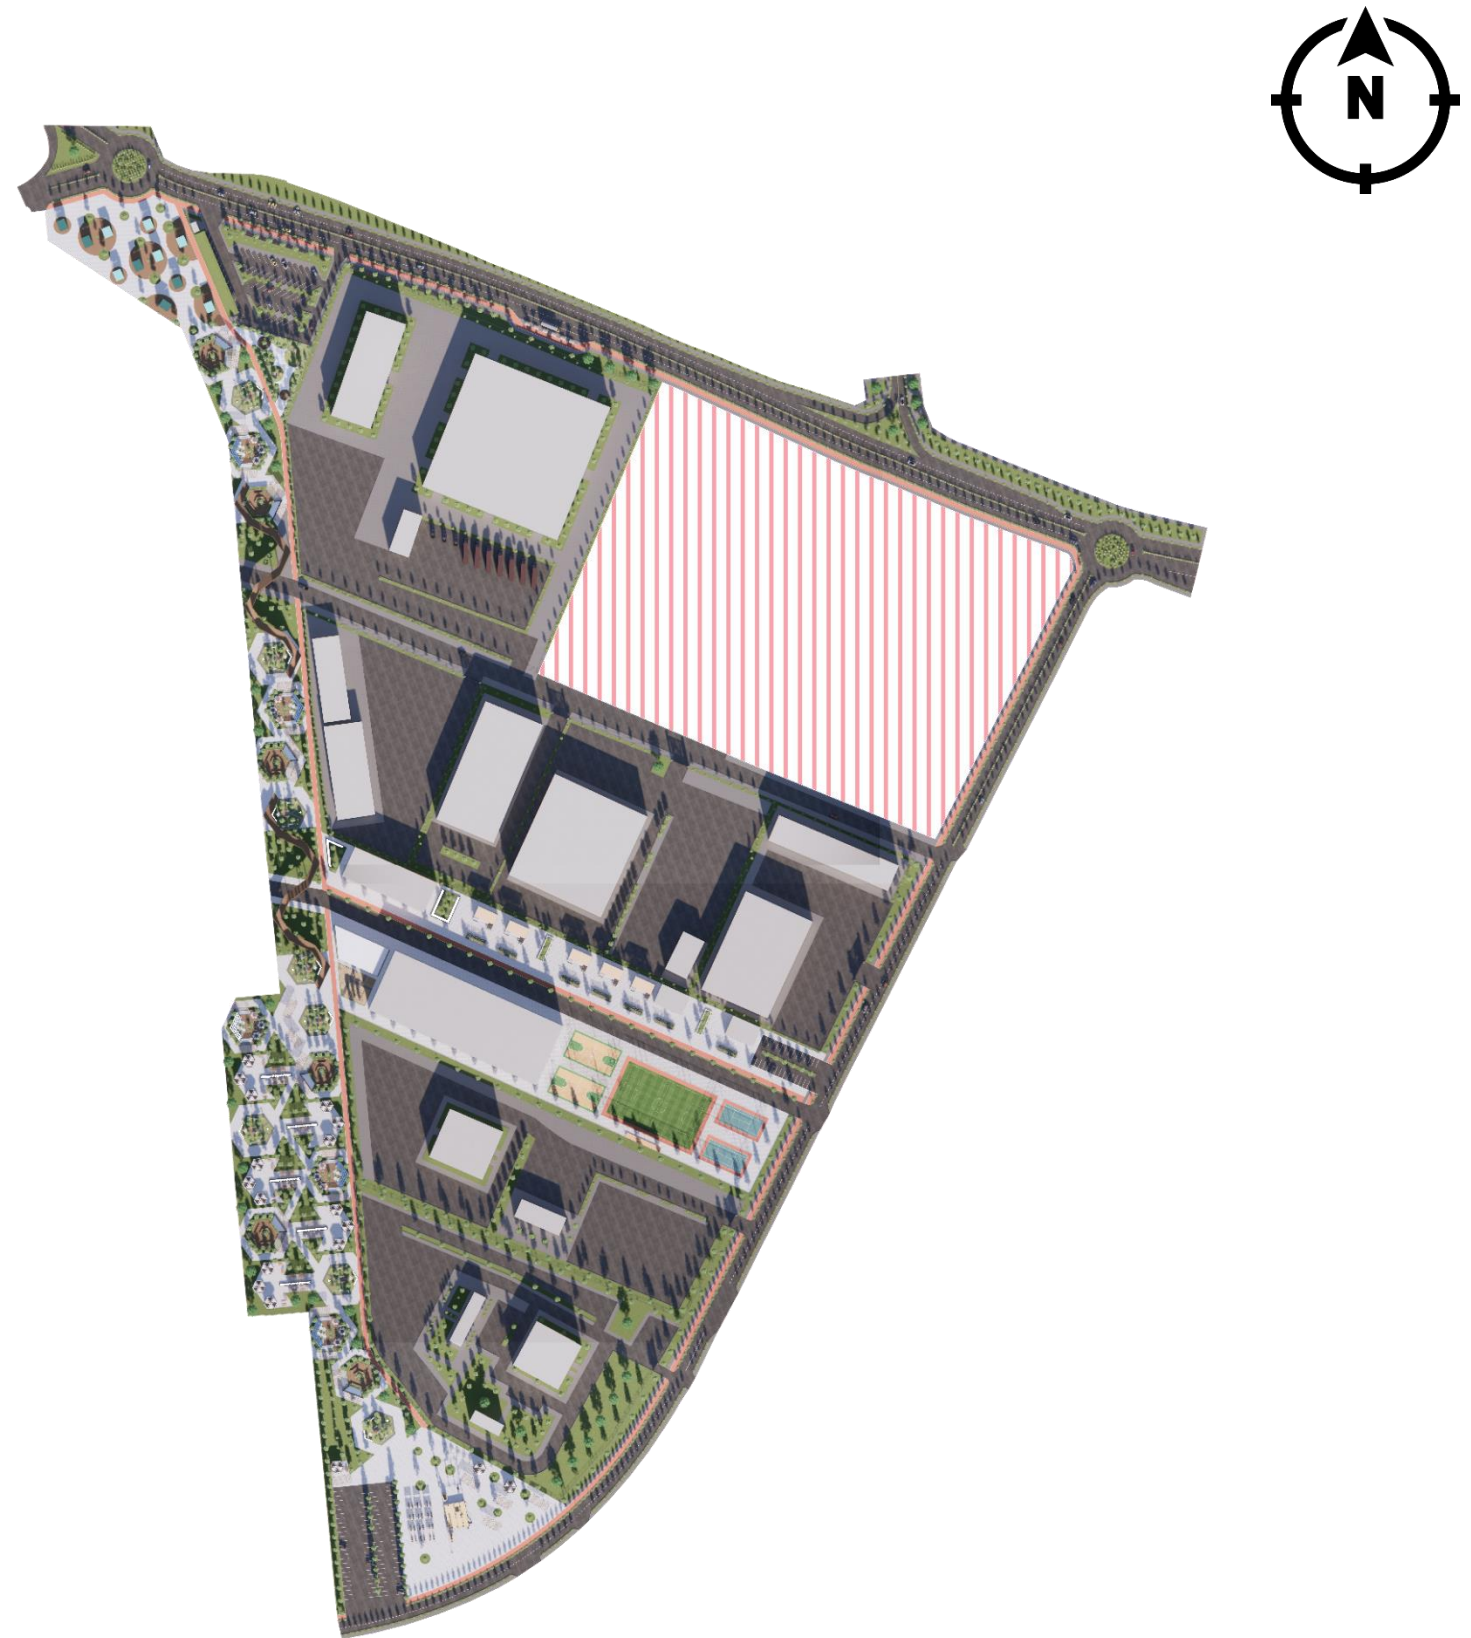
Plan d'Aménagement Urbain. Source : Auteur
